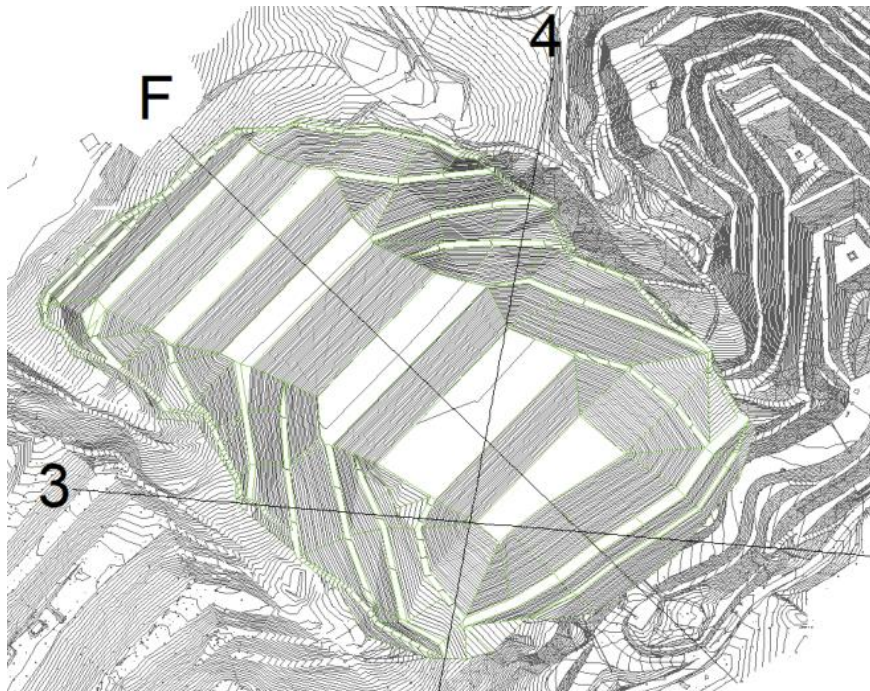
Planimetria di fondo discarica con indicazione delle sezioni di verifica in configurazione a scavi aperti/discardica vuota
